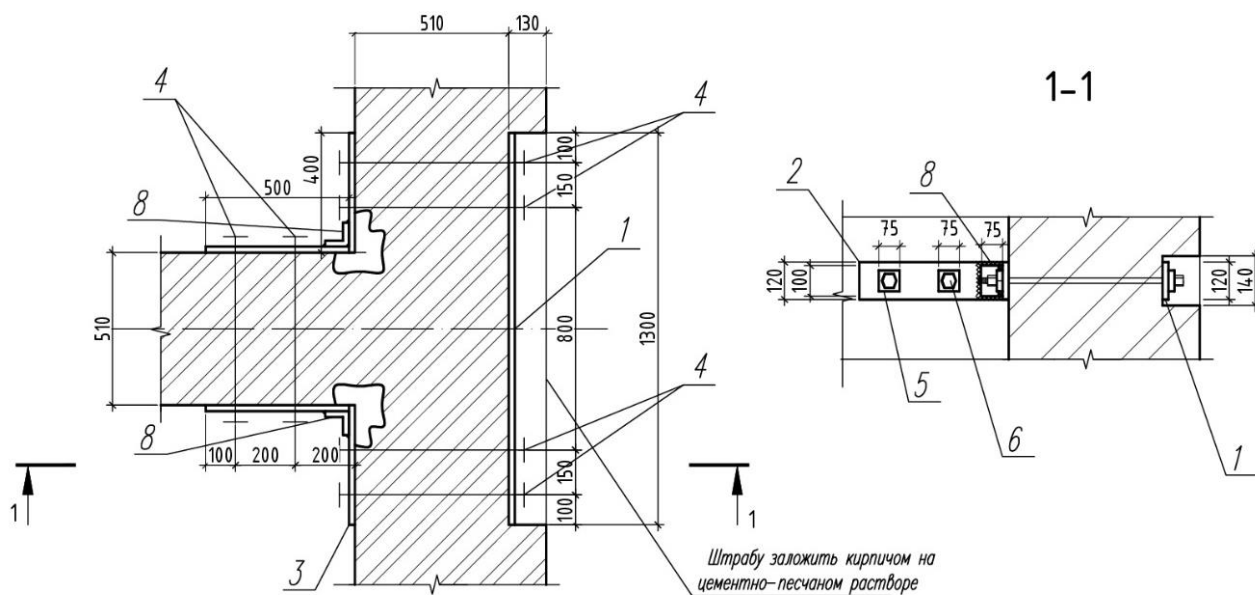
Схема усиления стальными накладками и стяжными болтами
